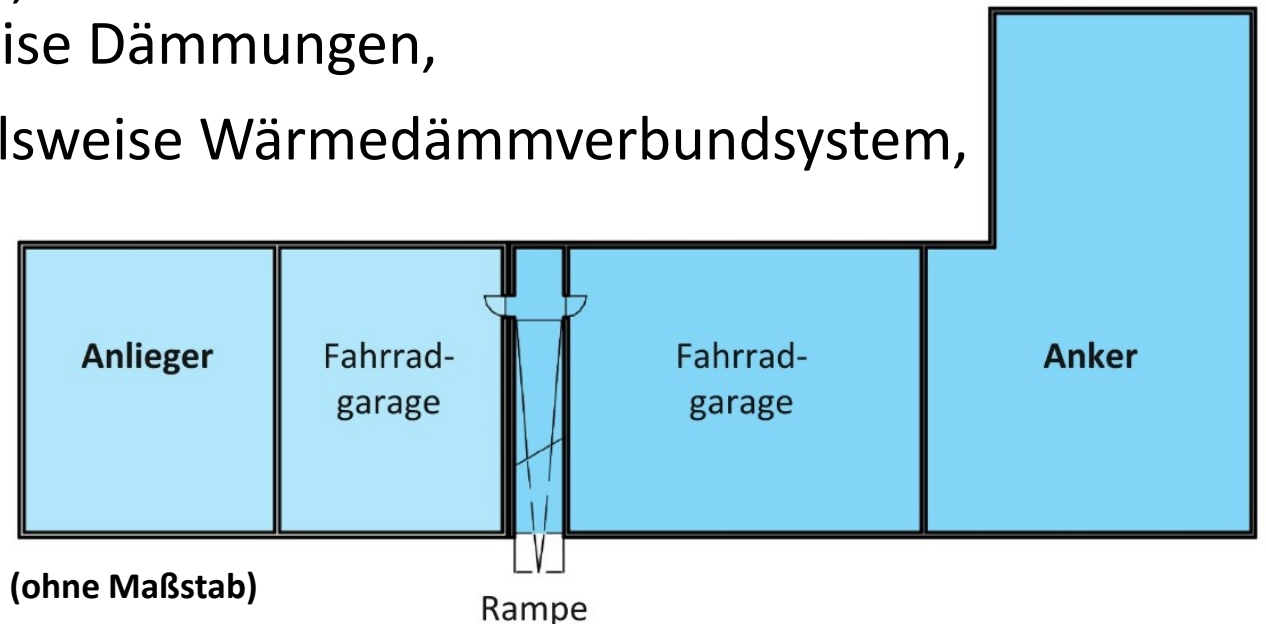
schematischer Grundriss des Untergeschosses vom MU 7 (ohne Maßstab)
